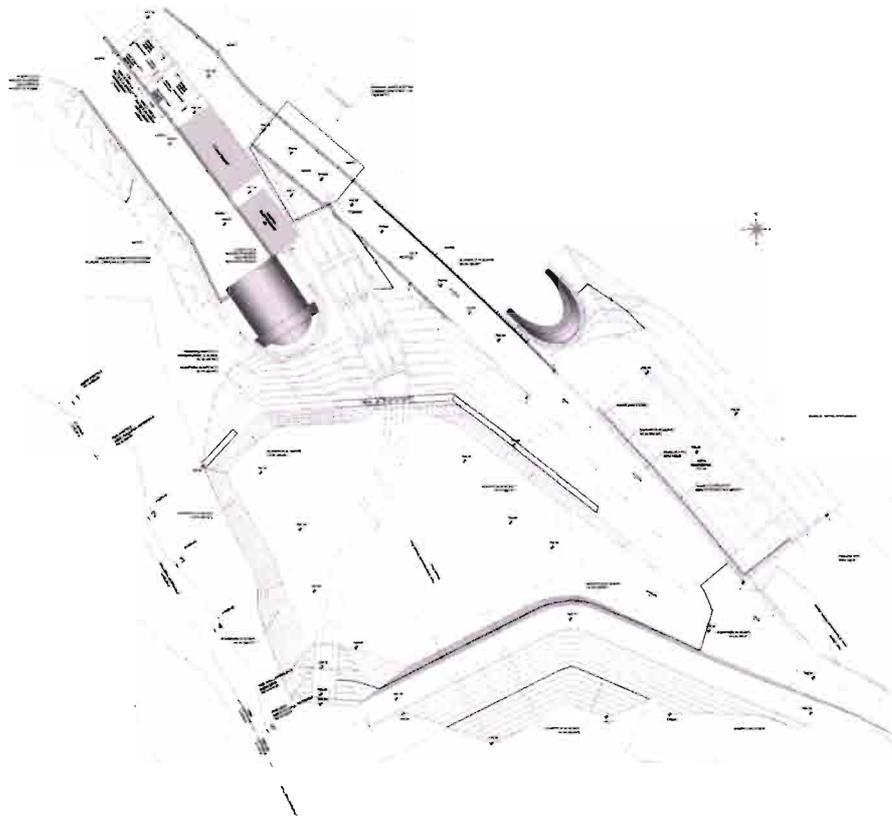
Stralcio planimetrico dell'imbocco dell'interconnessione pari.
